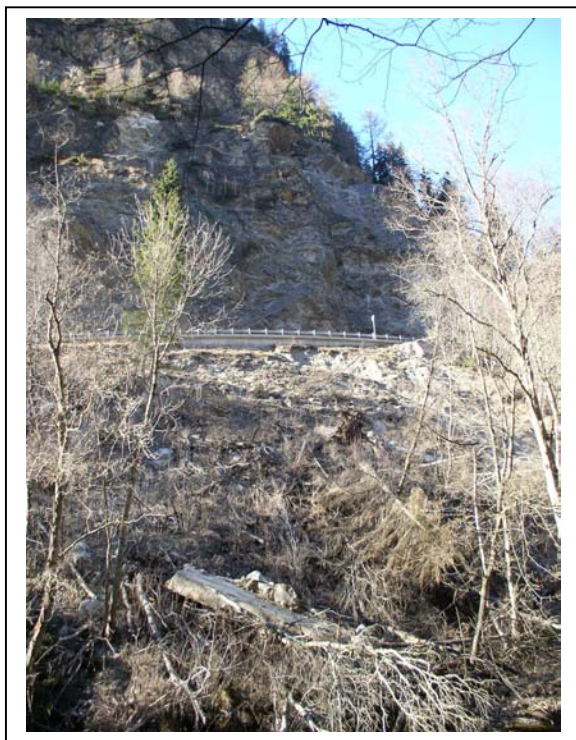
L'area di cantiere della zona d'imbocco della galleria d'accesso „Vizze“ è prevista nel pendio acclivo a valle della strada provinciale della Val di Vizze (vista dal Rio Vizze sulla strada provinciale)
